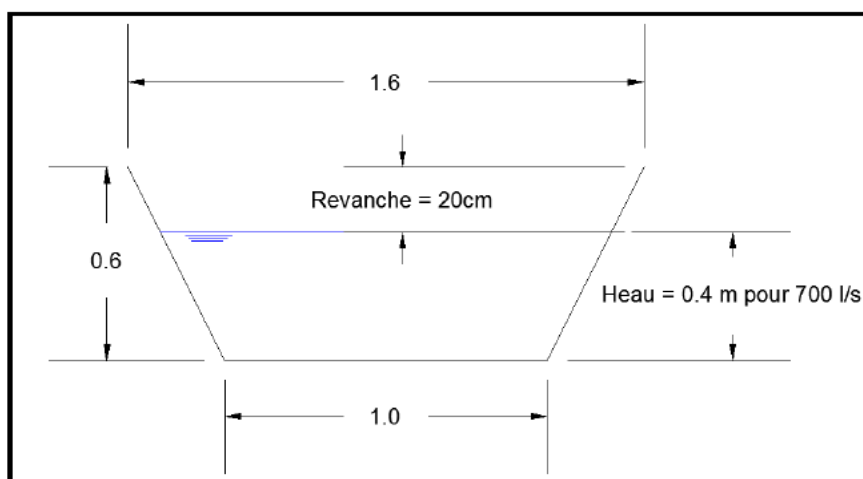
Coupe type du rétablissement du canal de Gaubert
